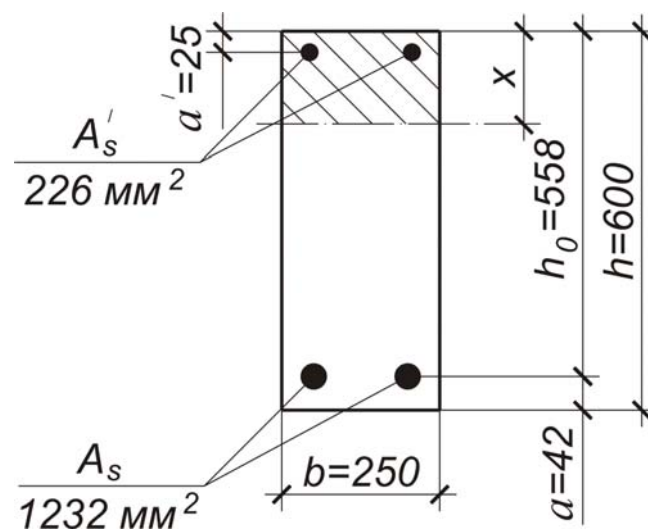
Расчетное нормальное сечение ригеля в пролете
